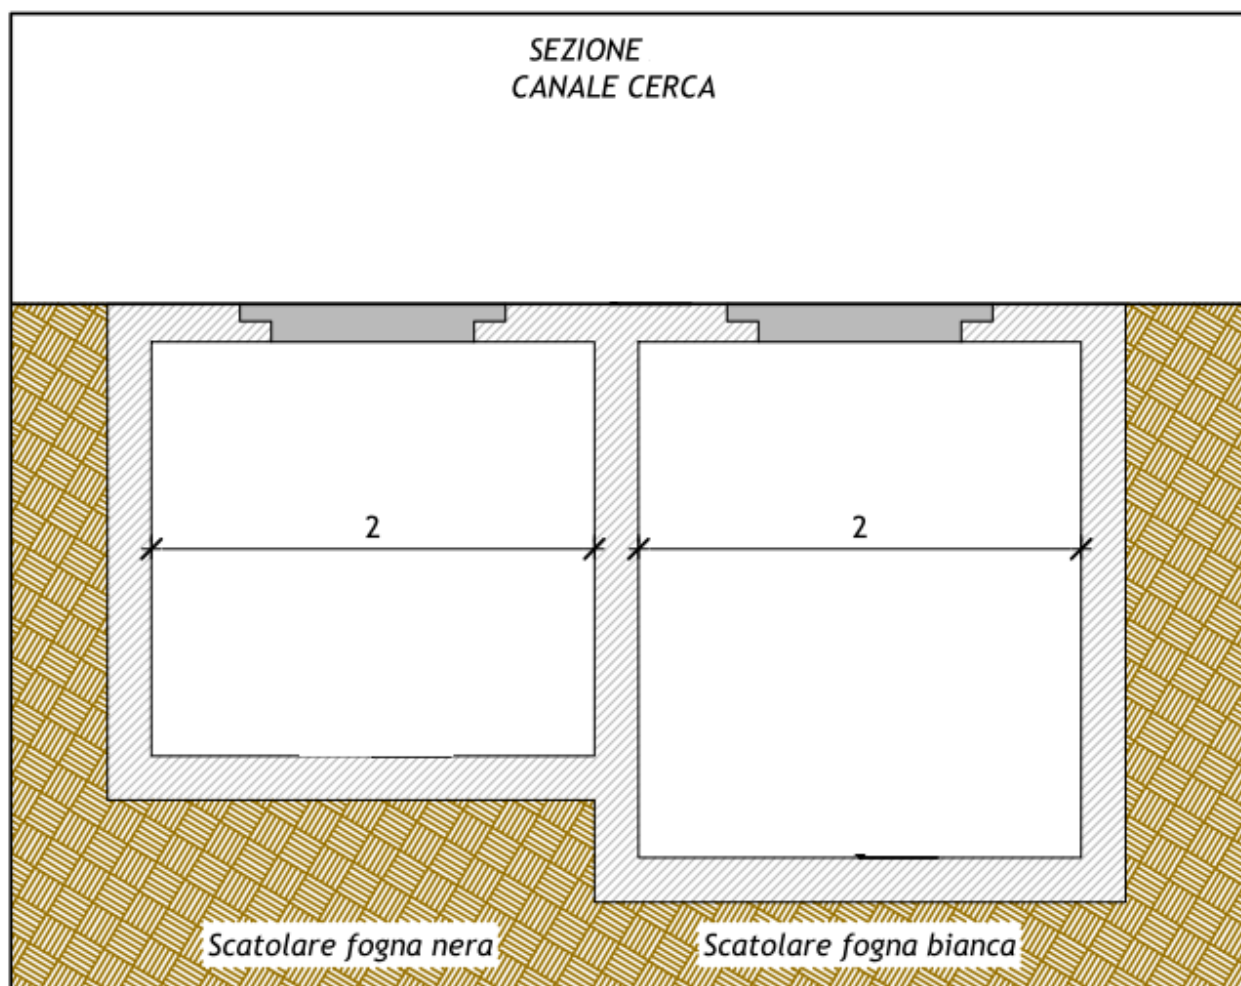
Sezione tipo del Canale Cavo Cerca, individuato come recapito della rete di drenaggio.
